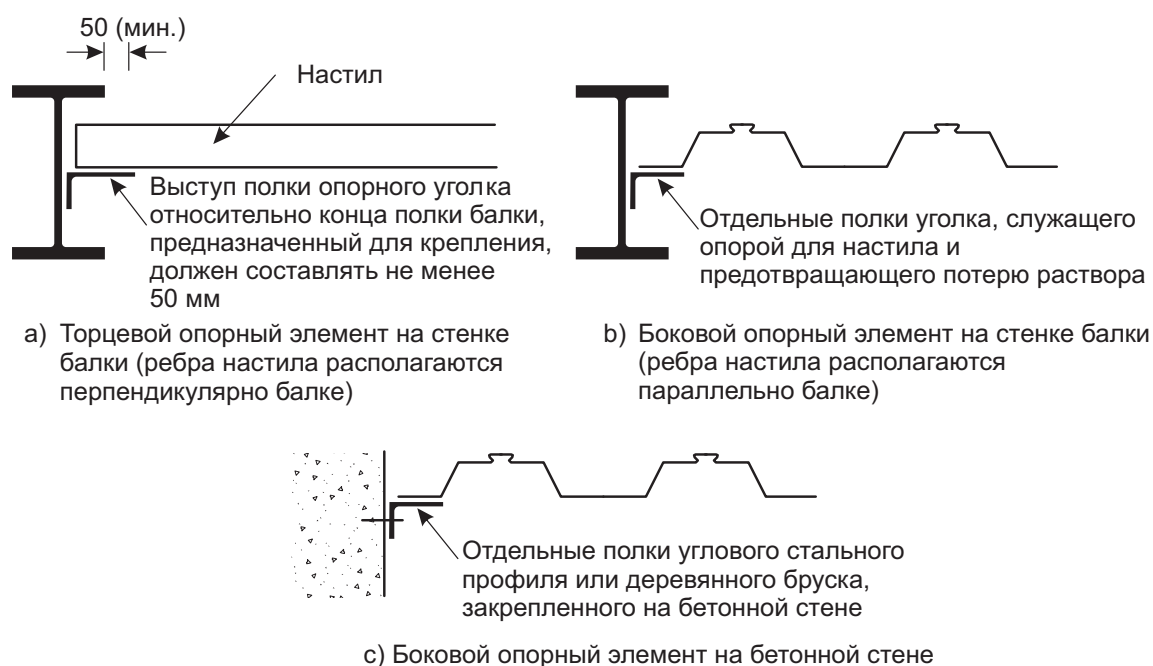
Вид опорных элементов настила на стенке балки и бетонной стене
